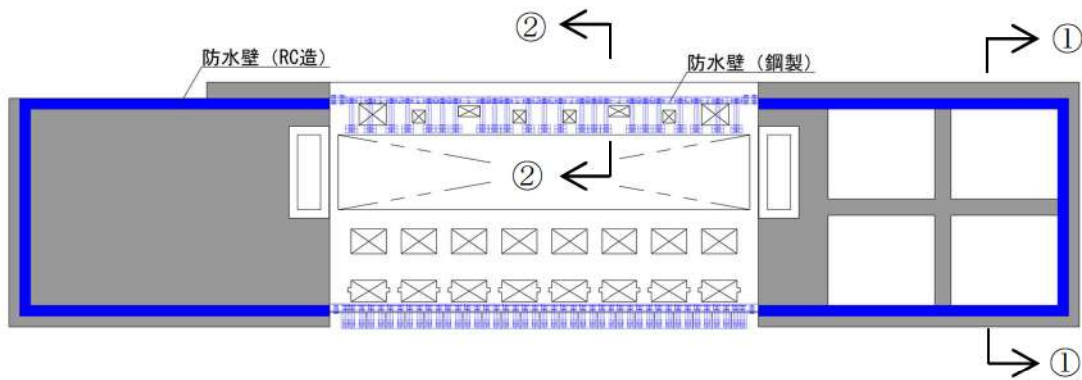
1号及び2号炉取水ピットスクリーン室防水壁 平面図
